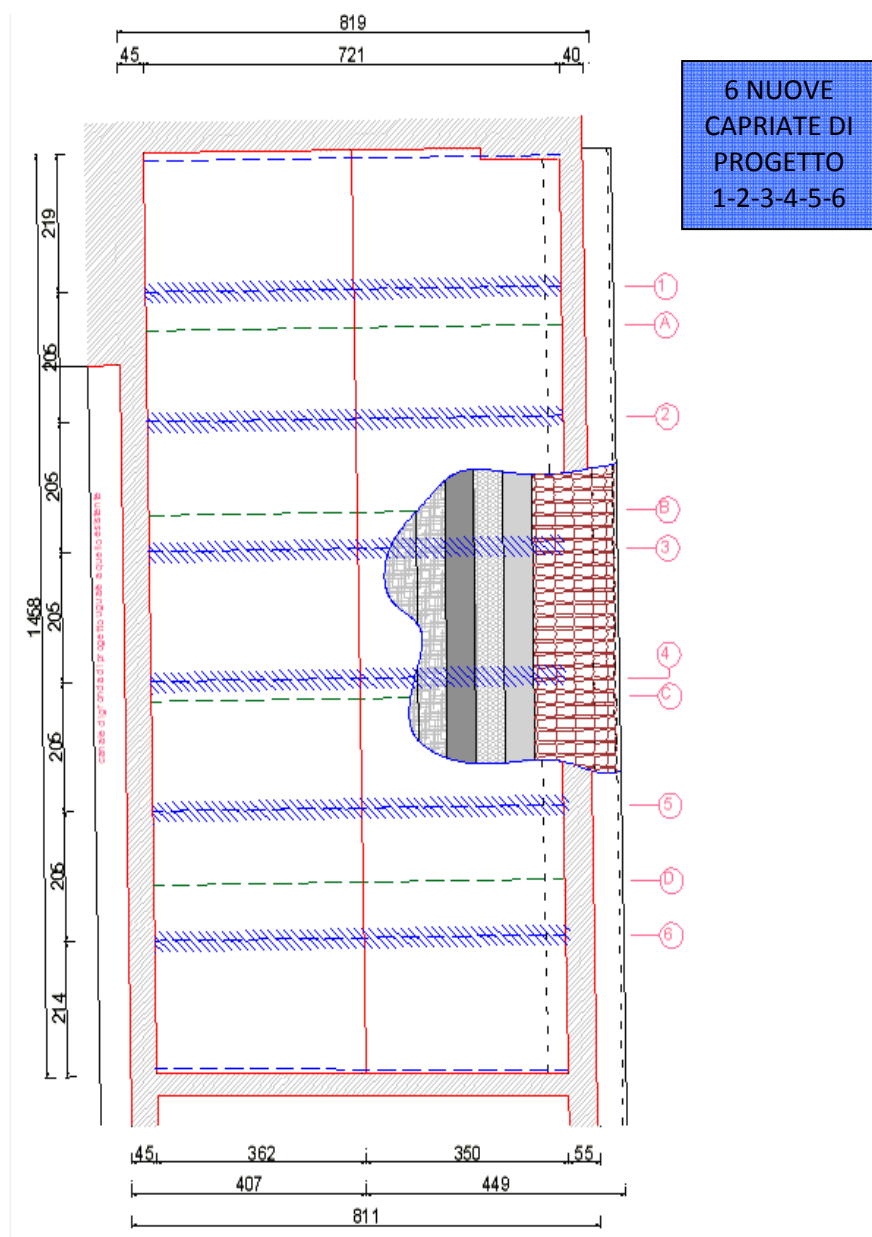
Pianta copertura di progetto - Teatro "Ebe Stignani" di Imola
